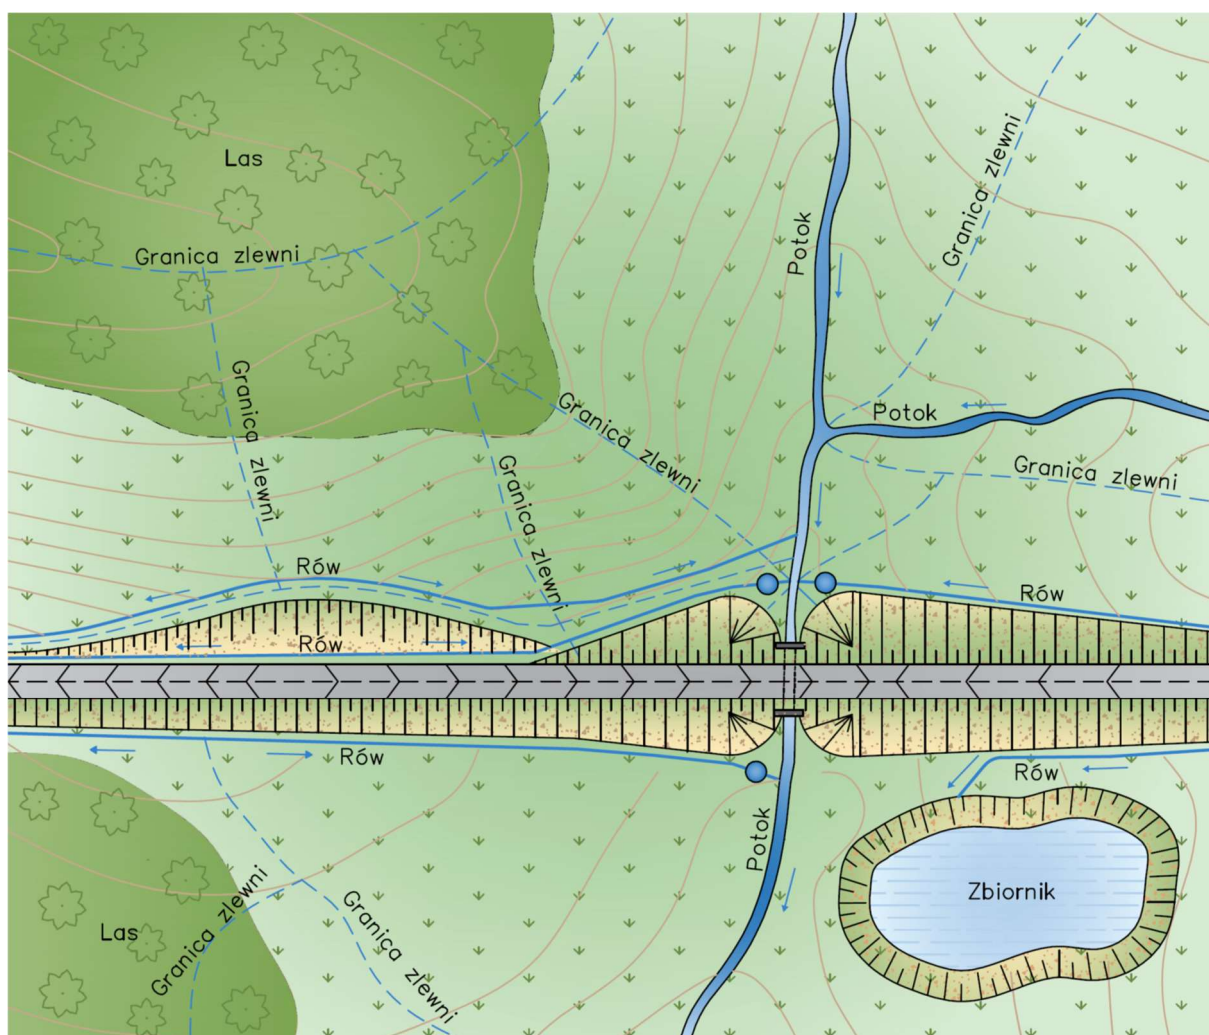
Przykładowe schematy urządzeń do redukcji zanieczyszczeń wód opadowych i roztopowych
